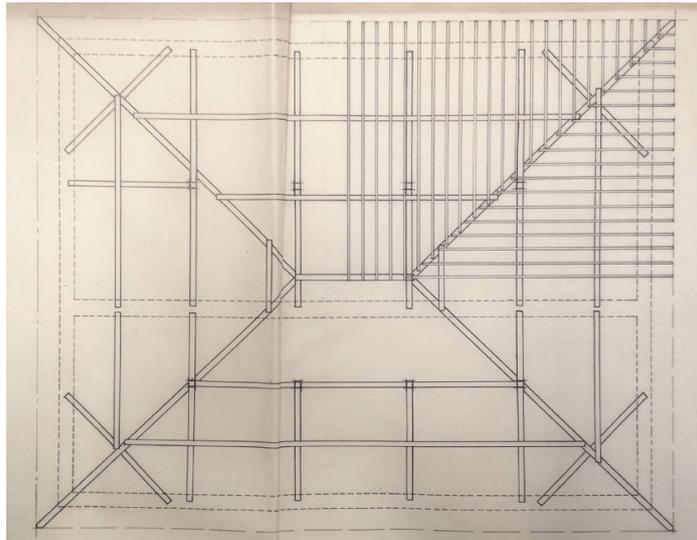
Damian Lizaur. Planta del tejado de Jausoro Garaikua. Fuente: Archivo Municipal de Oñati; Fondo Damian Lizaur. C.1235, exp.3.
